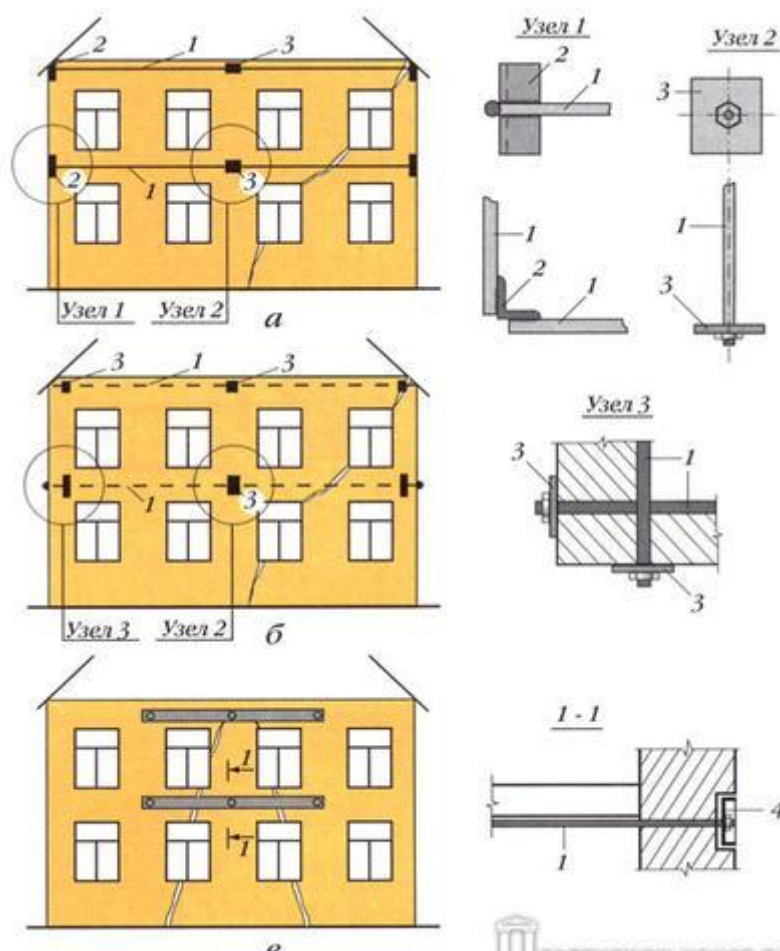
Усиление стен: а, б - стальными тяжами с наружной (а) и внутренней (б) сторон здания; в - установкой ненапрягаемых тяжей; 1 - тяж; 2 - уголок; 3 - опорная стальная пластинка; 4 - швеллер.
